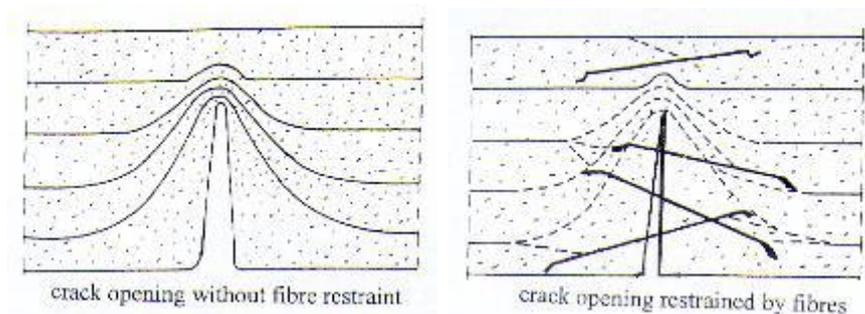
Effet de retardement de la fissuration du béton avec fibres.
